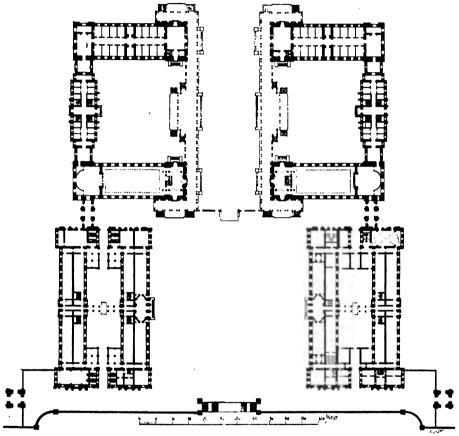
Hospital zu Greenwich. Grundriss.
